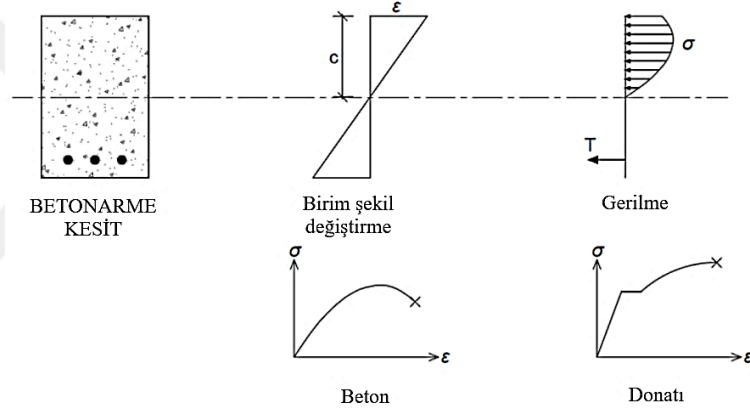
Eğilme etkisi altında betonarme bir kesit (Celep, 2008)
